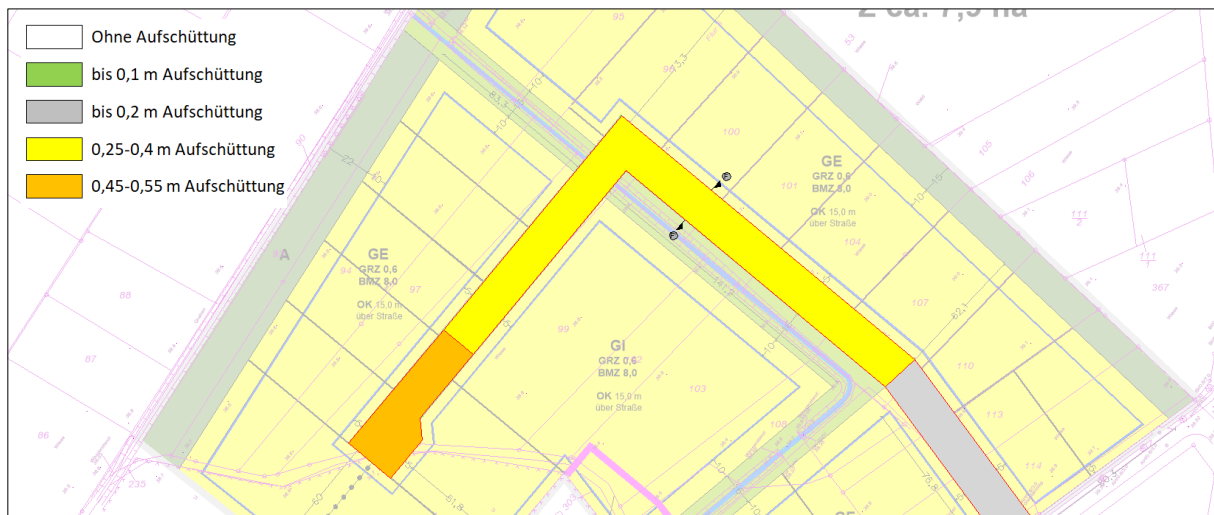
erforderliche Aufschüttung Planstraße 1
